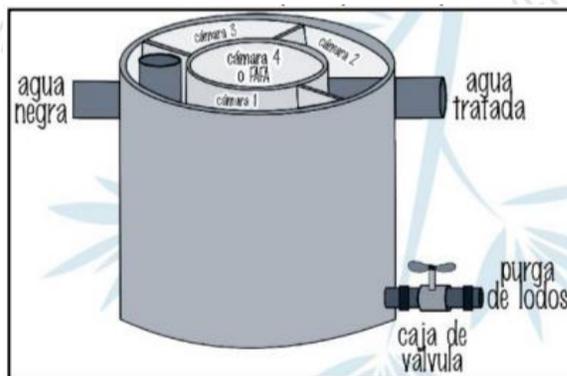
sistema de tratamiento prefabricado, empleado en Reten Puente 1.
